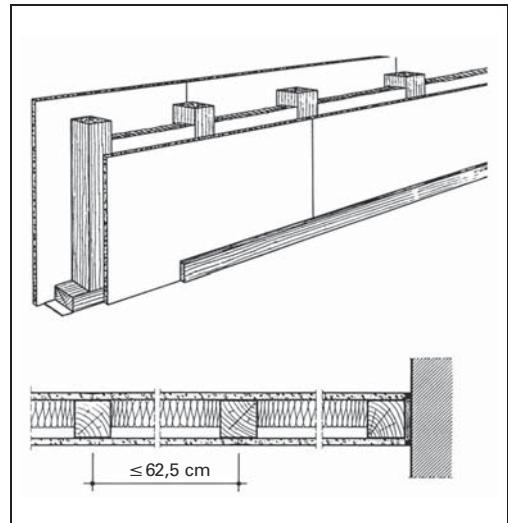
Holzeinfachständerwand, einfach beplankt
